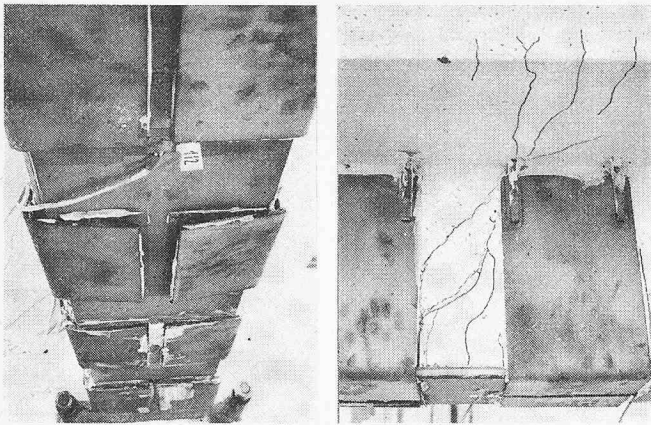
, links aussen. Abgelöste Schubbewehrung bei 2,5facher Gebrauchslast
